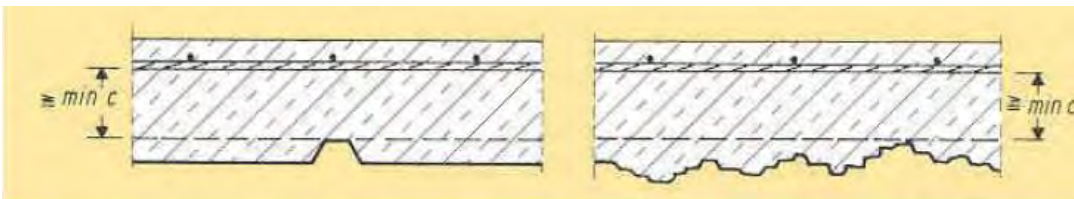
Lokal reduzierte Betondeckung durch Tropfnasen oder Oberflächenprofilierung
